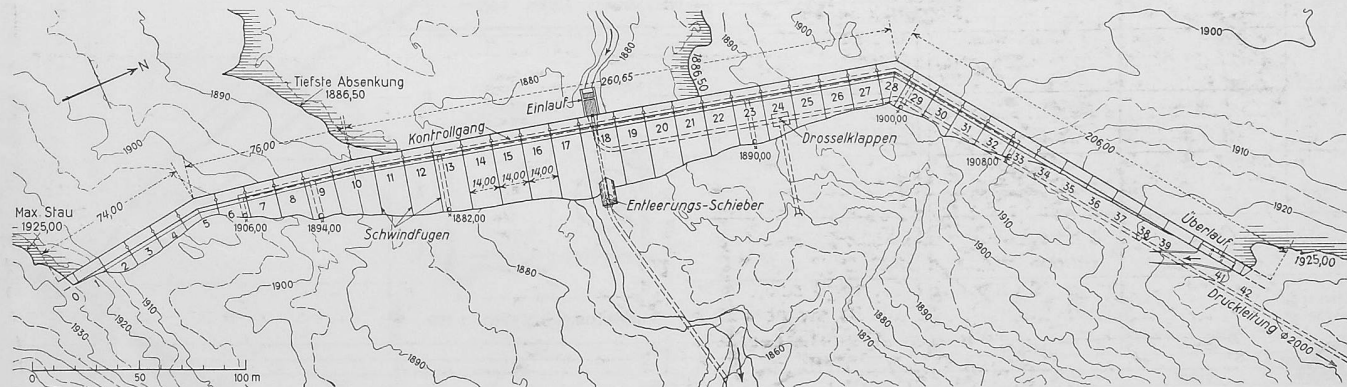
Grundriss der Salanfe-Staumauer 1: 3500
